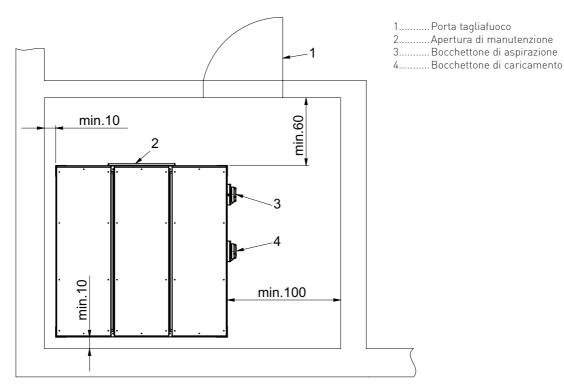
Vano di installazione e serbatoio in lamiera d'acciaio – vista dall'alto
